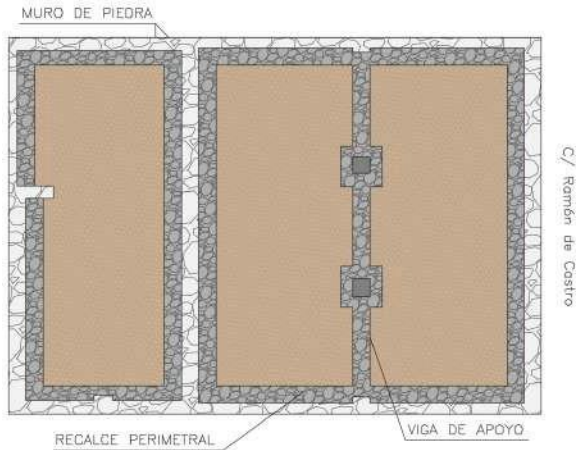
Distribución del recalce perimetral y vigas de apoyo de la vivienda. Fuente propia
